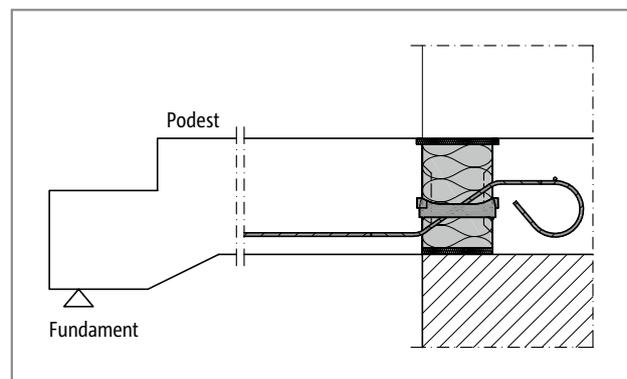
Schöck Isokorb® XT typ QL: Anschluss Treppenpodest bei einschaligem, wärmedämmendem Mauerwerk (XT typ QL-V1 bis V4)
